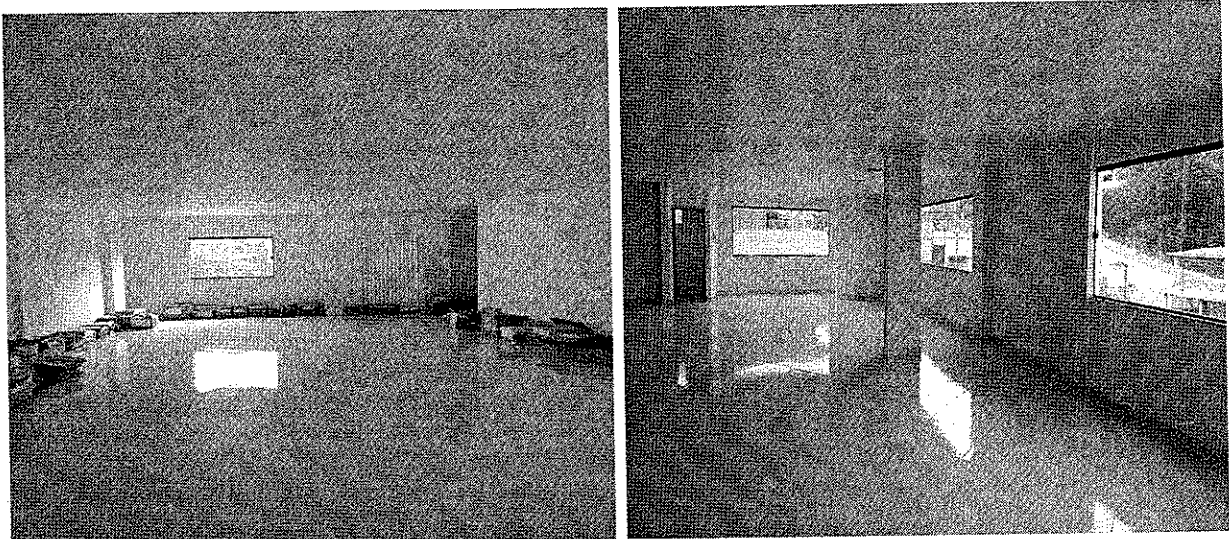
Ambiente interno com revestimentos cerâmicos, janelas em vidro de segurança e rebaixamento em forro PVC.
